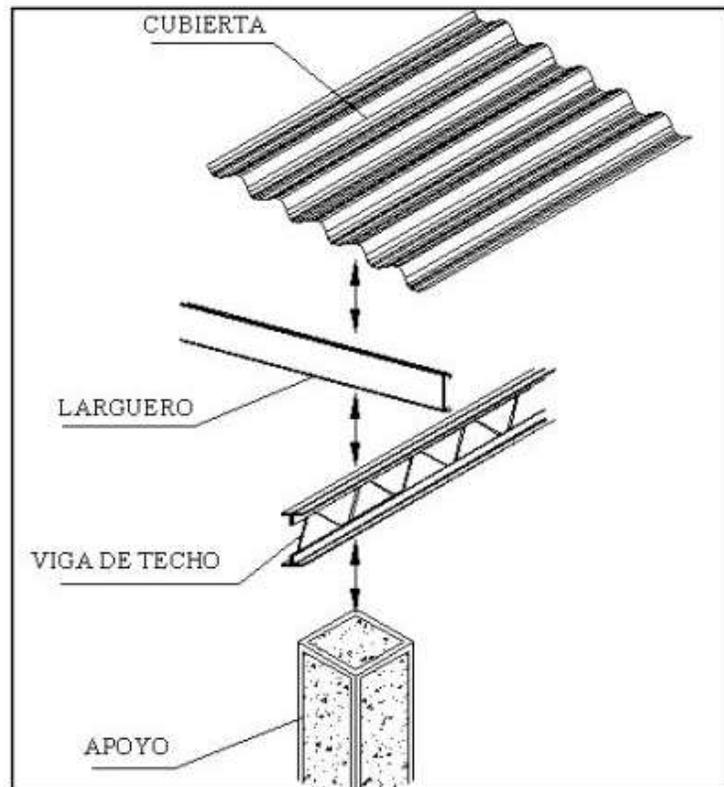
Ejemplo de estructura de techo metálico.
